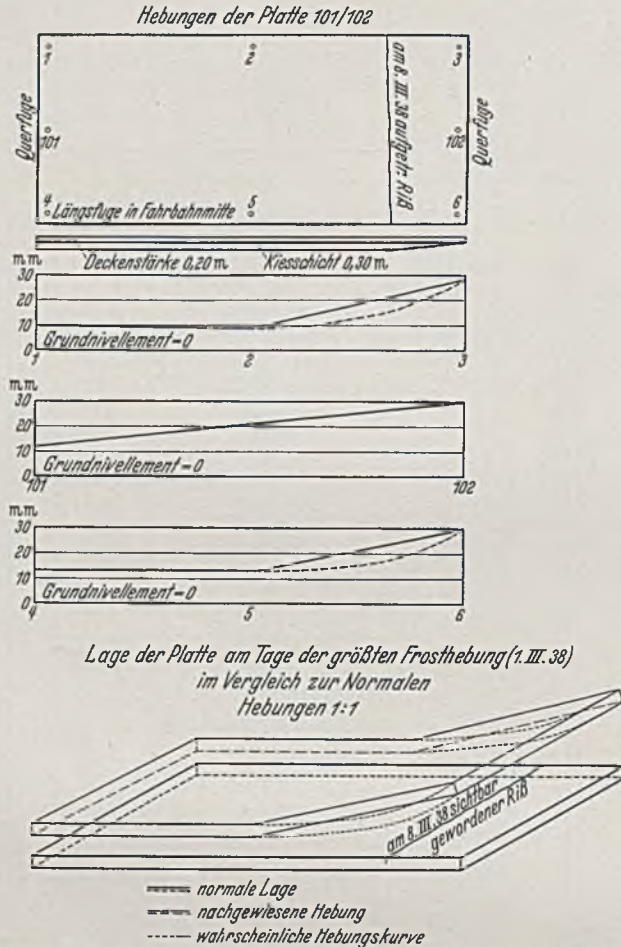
Darstellung der Beanspruchung schadhafter Betonplatten durch Frost.
